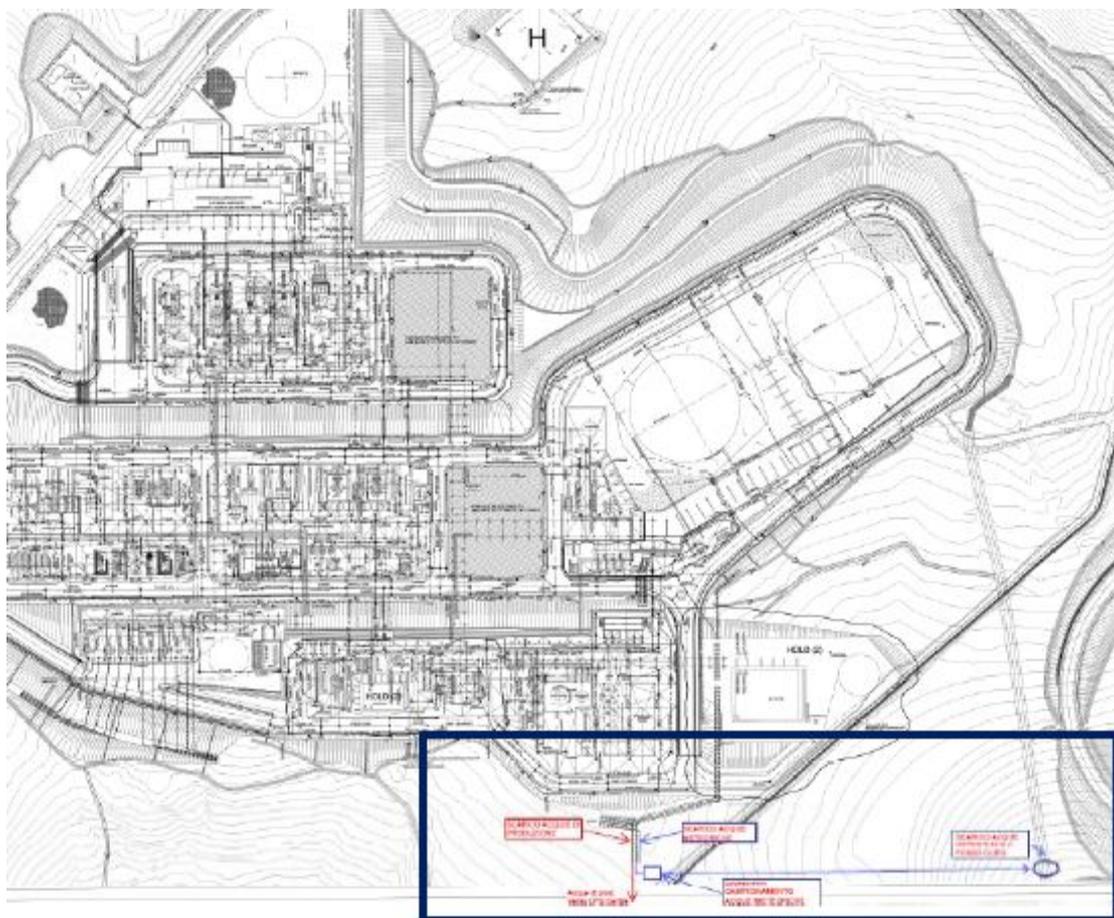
Planimetria d'insieme con individuazione del pozzetto di campionamento e dello scarico delle acque di dilavamento OD1 e OD2 e reflue civili
